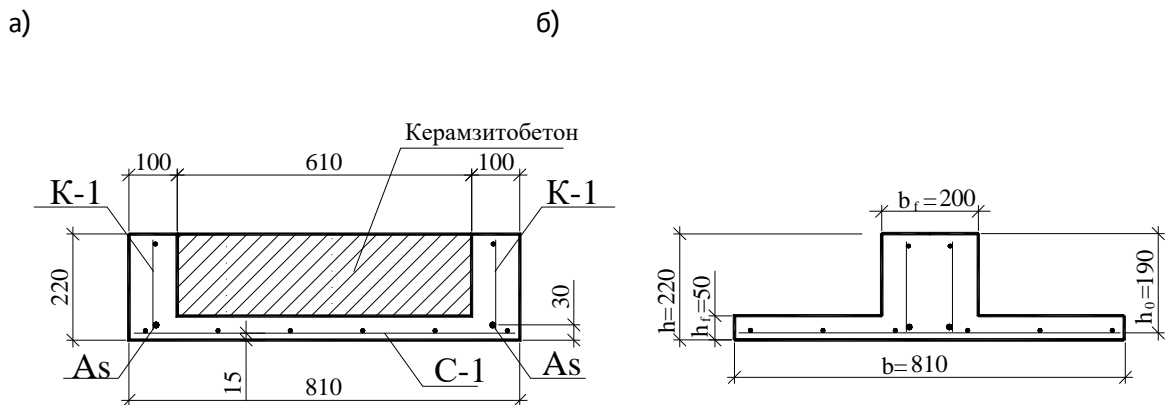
Схеми: а) поперечного перерізу плити; б) приведенного перерізу плити.
